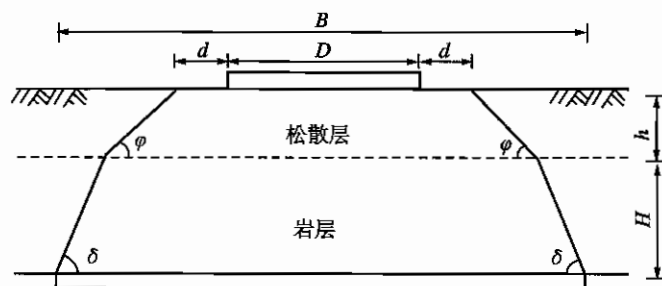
水平矿层采空区处置宽度计算简图
